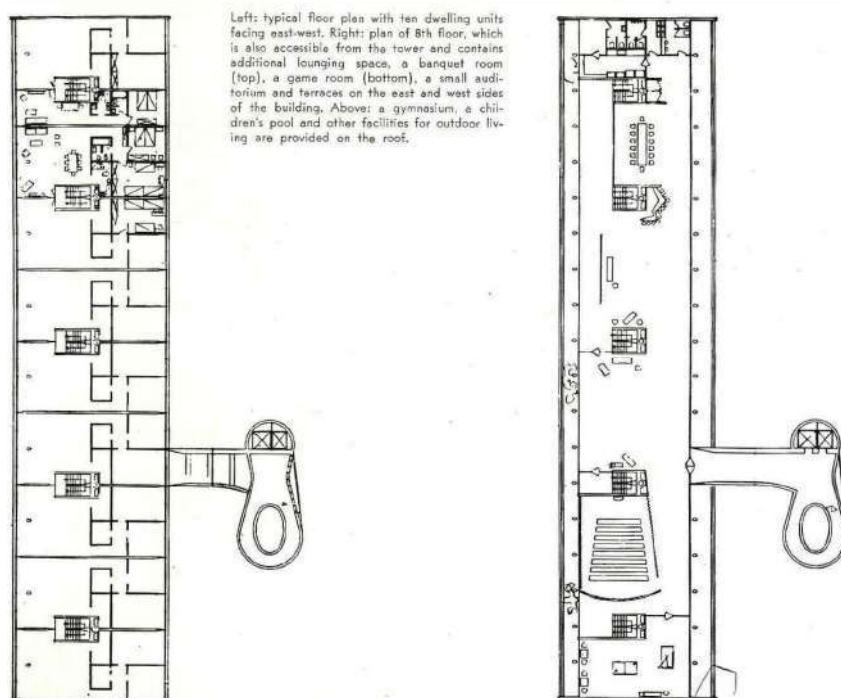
Edifício para a Exposição Interbau em Berlim, plantas baixas do pavimento-tipo (esquerda) e do oitavo pavimento (direita).
